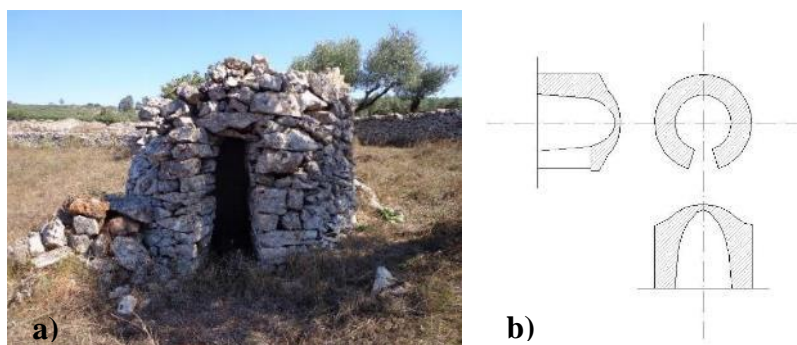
Abrigo de pastor isolado circular: a) Vista geral; b) Planta e corte
